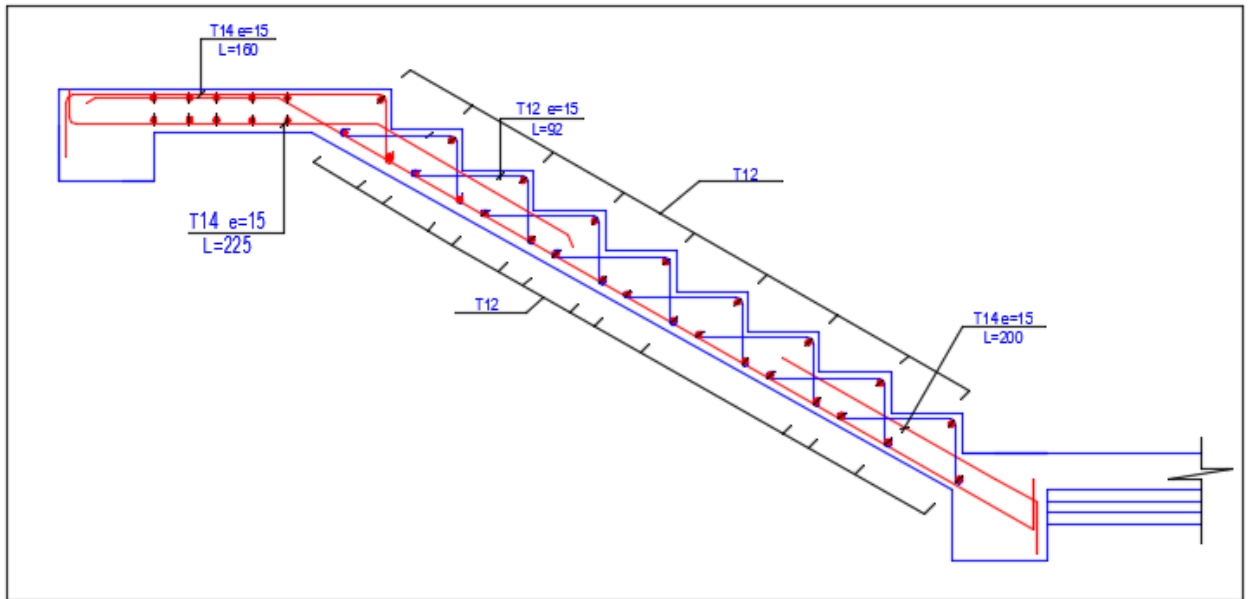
Schéma de ferrailage d'un escalier type 2 (cas volée 3).
